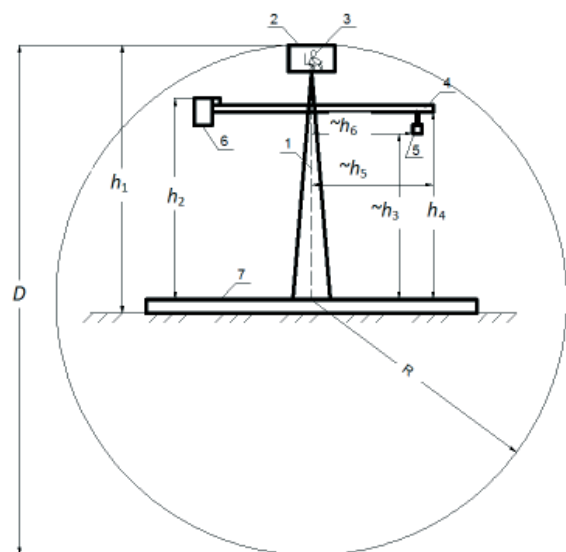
Схема травмоопасной зоны вокруг строительного башенного крана: 1 – кран; 2 – кабина крана; 3 – оператор; 4 – стрела; 5 – груз; 6 – противовес; 7 – опорные рельсы крана; h_1 – высота крана; h_2 – высота крана и противовеса; h_3 – переменная высота расположения груза; h_4 – высота стрелы крана; R – радиус травмоопасной зоны вокруг крана; D – диаметр травмоопасной зоны крана
